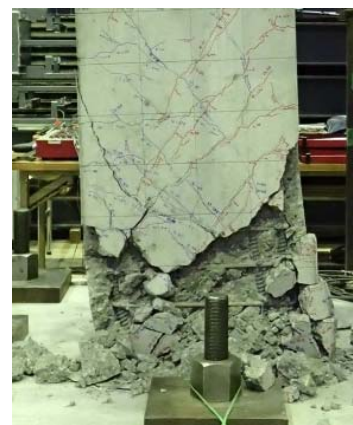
試験体のひび割れ状況と最終状況
